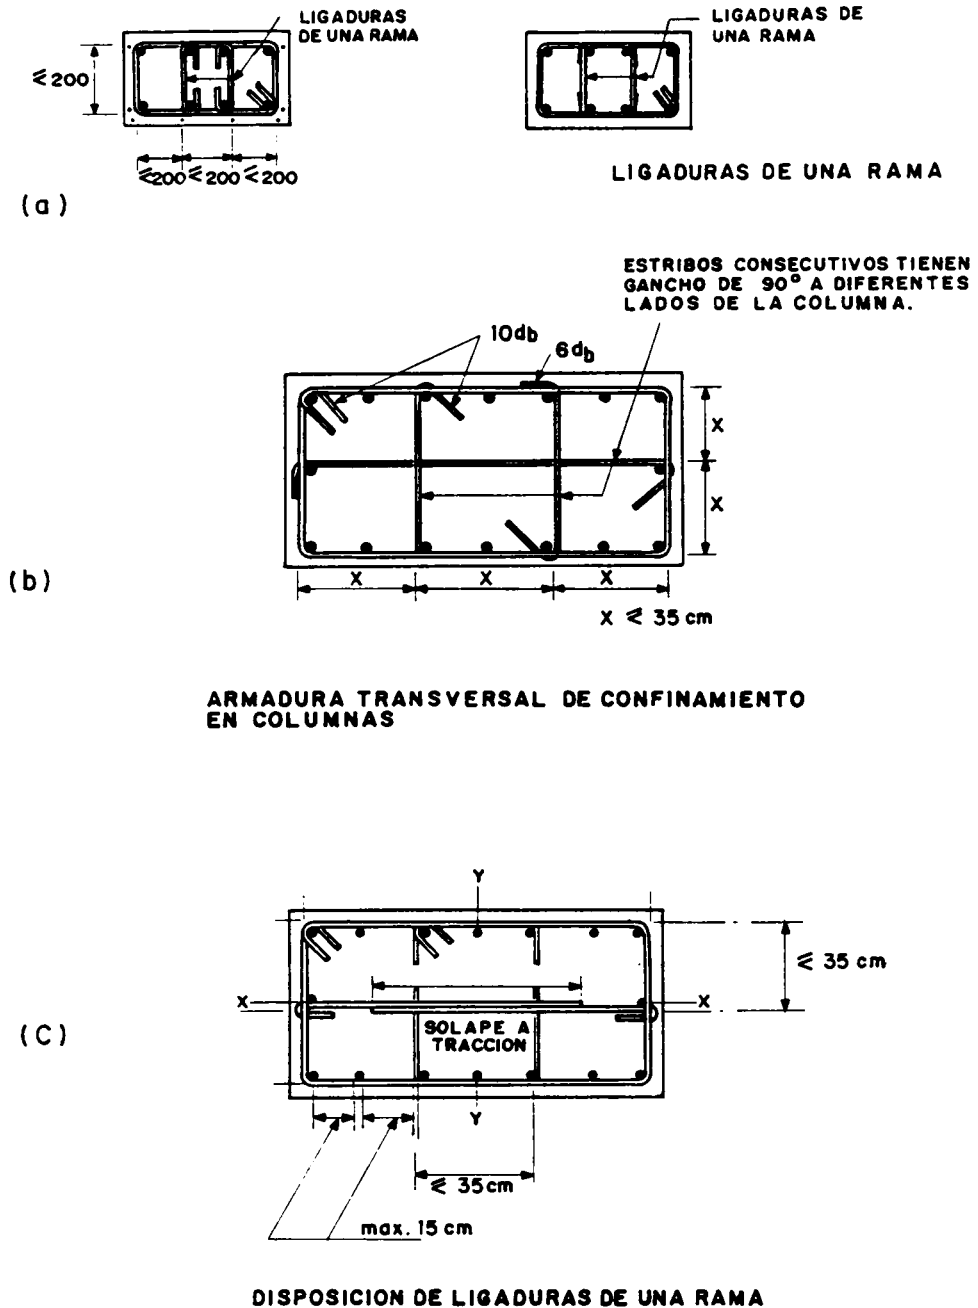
Ligaduras de una rama para refuerzo transversal en columnas.
